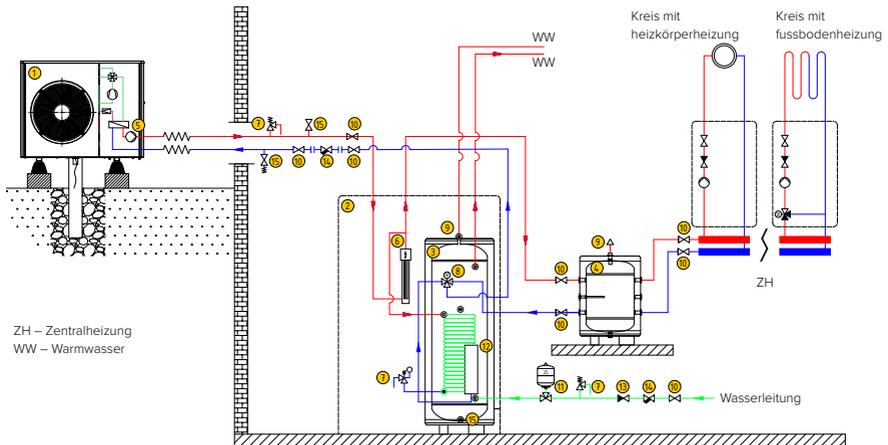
Plan der Hydraulikanlage mit Parallelpufferspeicher (Zentralheizung + Fußbodenheizung)
